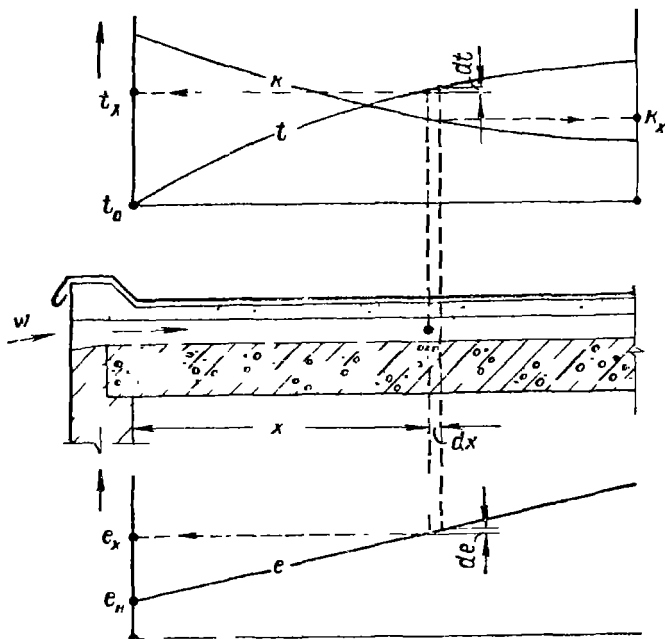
Расчетная схема для определения в покрытиях с вентилируемой воздушной прослойкой значений k , t и e
